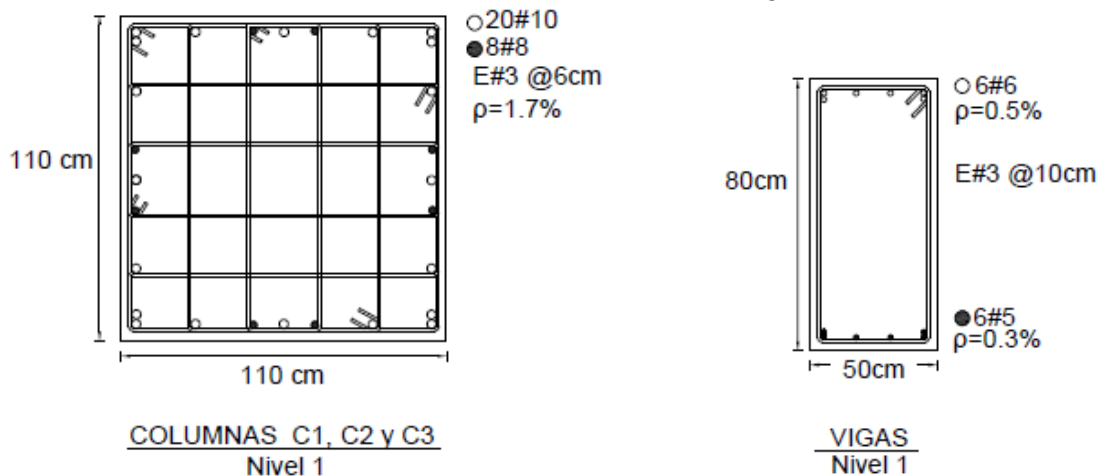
Armado de vigas y columnas diseñadas con las NTCC-17 para el edificio de 6 niveles cuyo sistema estructural consiste en marcos dúctiles y muros diafragma de mampostería no agrietada
